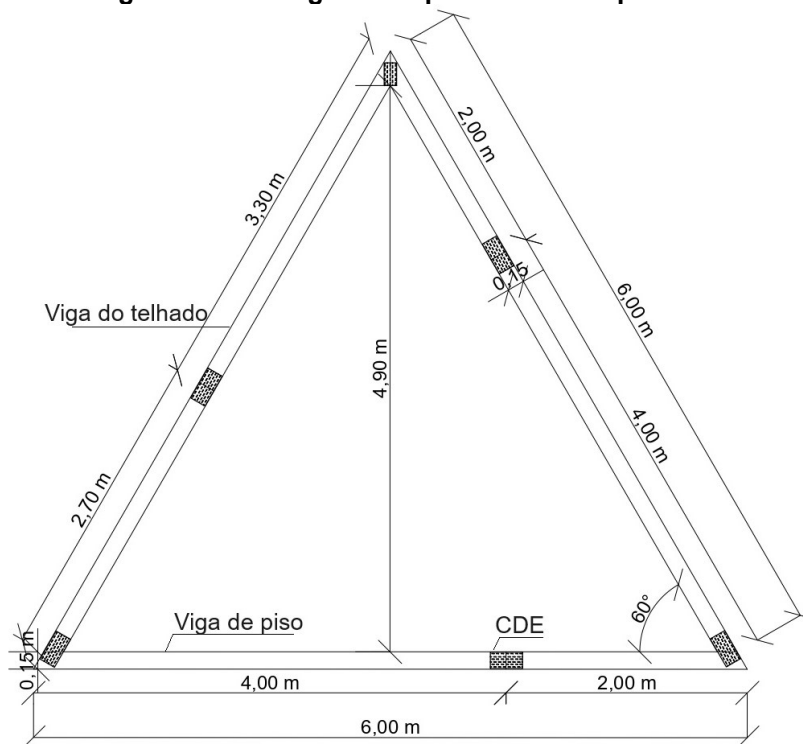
Ilustração da mesa gabarito para o corte das vigas
